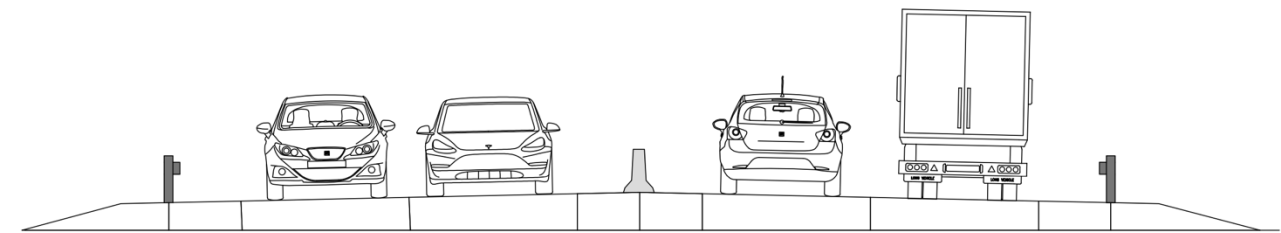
Sección transversal tipo | Fuente: Elaboración propia
